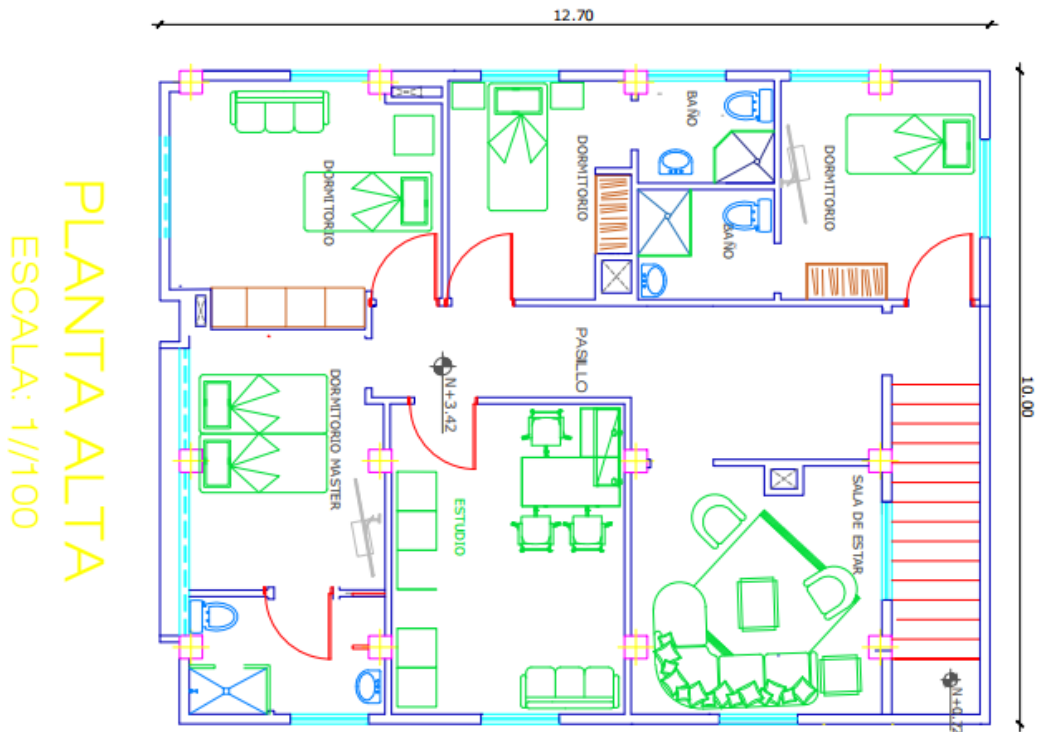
Plano arquitectónico de Planta Alta de la vivienda (Escala 1/100)
